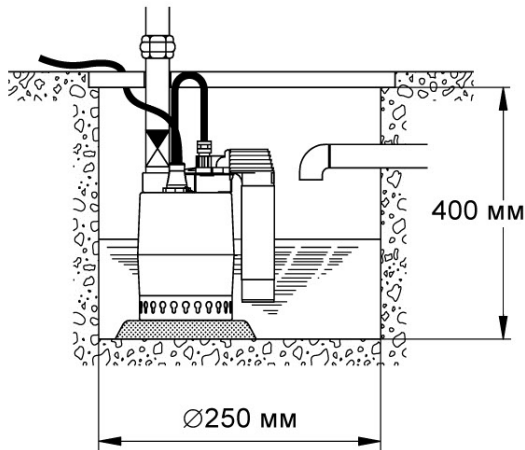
Мин. размеры резервуара для Unilift KP-AV
